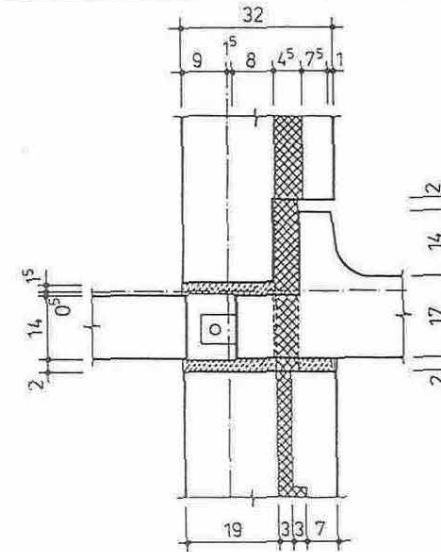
WHH GT ETP - Detail - Außenwand - Loggiadecke
